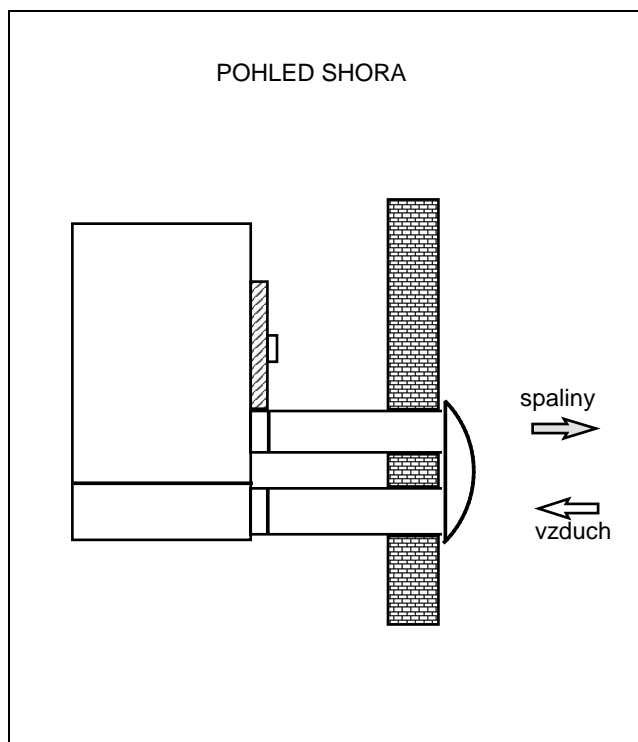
INSTALACE TYPU B23 S ODTAHEM PŘES STĚNU
